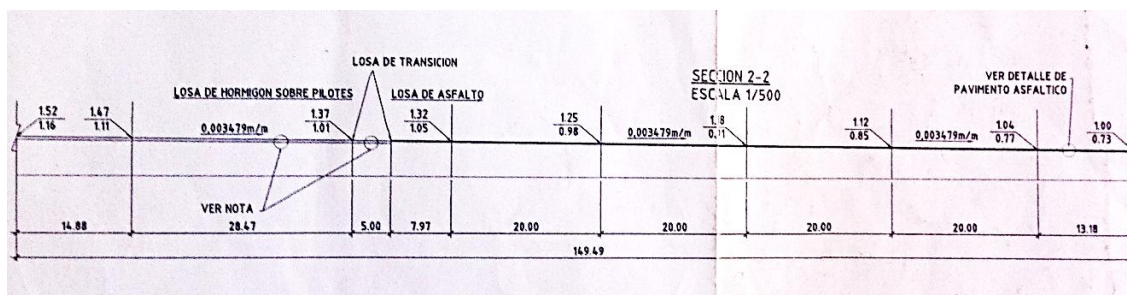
a) Elevación transversal de la losa del *Travel Lift*. Fuente: Plan General.
